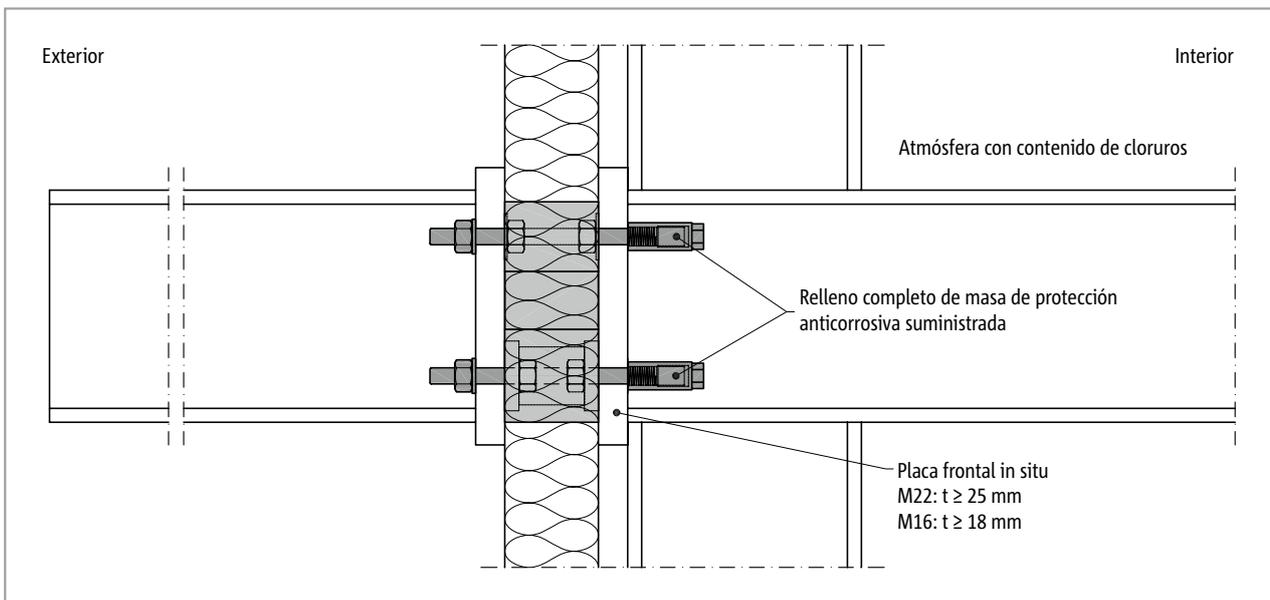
Schöck Isokorb® T tipo S con tuercas ciegas: Construcción de acero en voladizo; atmósfera interior con contenido de cloruros
